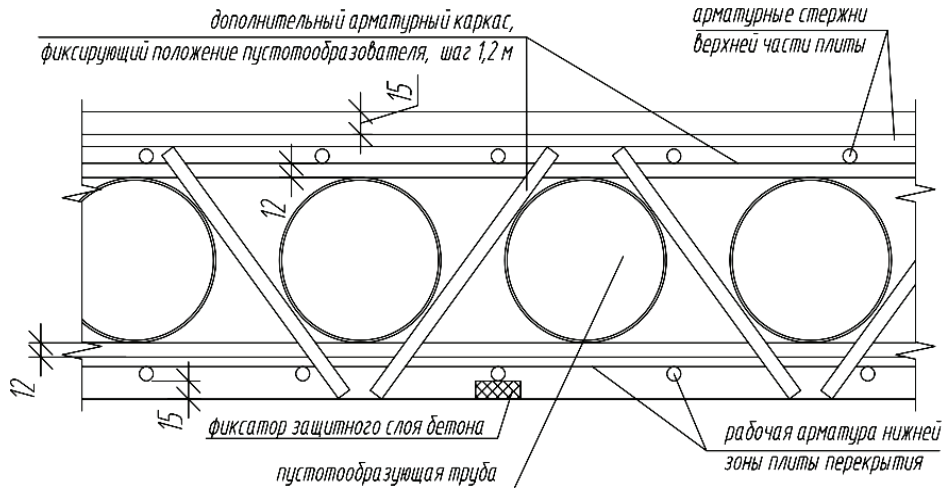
Конструктивная схема плоского монолитного перекрытия с цилиндрическими пустотами (разрез).
